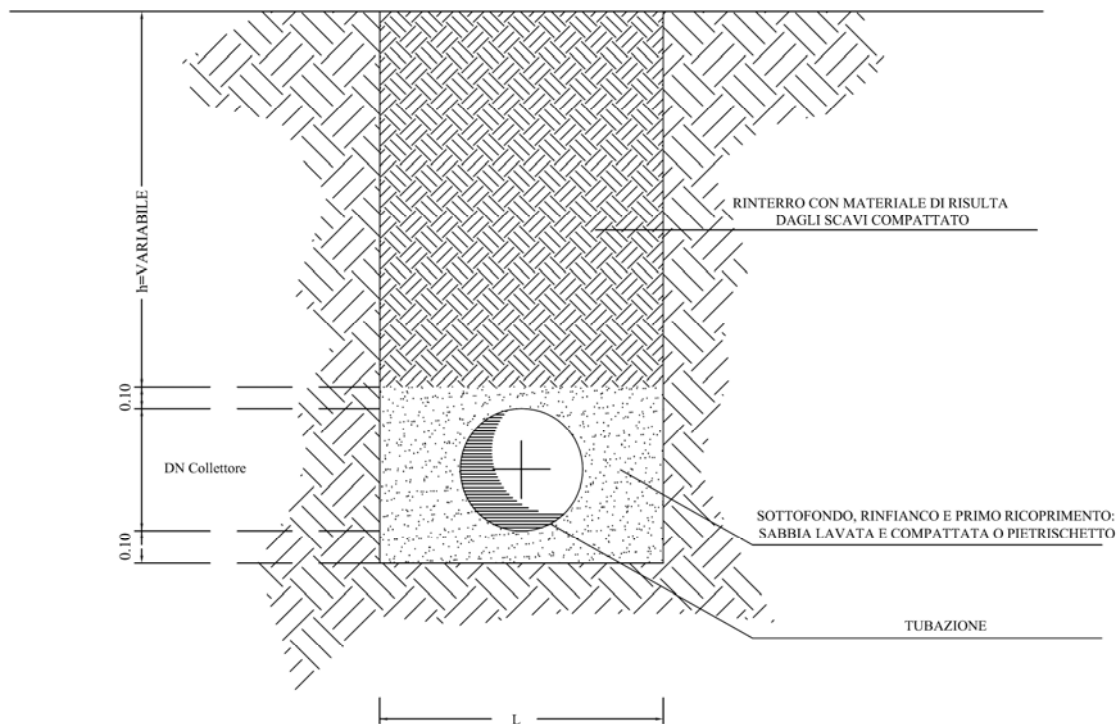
Sezione tipo di posa delle condotte in terreno nudo
